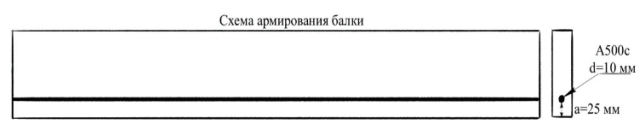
Схема армирование железобетонной балки арматурой классом А500с диаметром 10 мм с защитным слоем 25 мм
